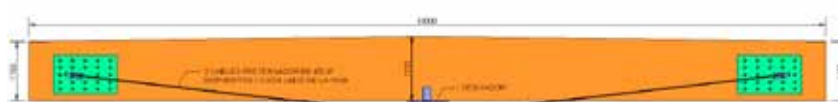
Esquema de refuerzo por cables de tesado vigas centrales.
